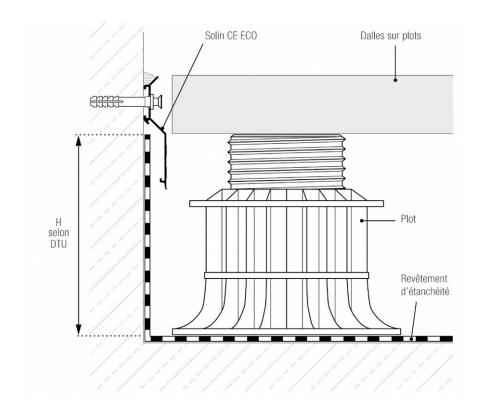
Toiture-terrasse accessible aux piétons et au séjour avec dalles sur plots et niveau fini des dalles au-dessus du haut des relevés avec Solin CE ECO
